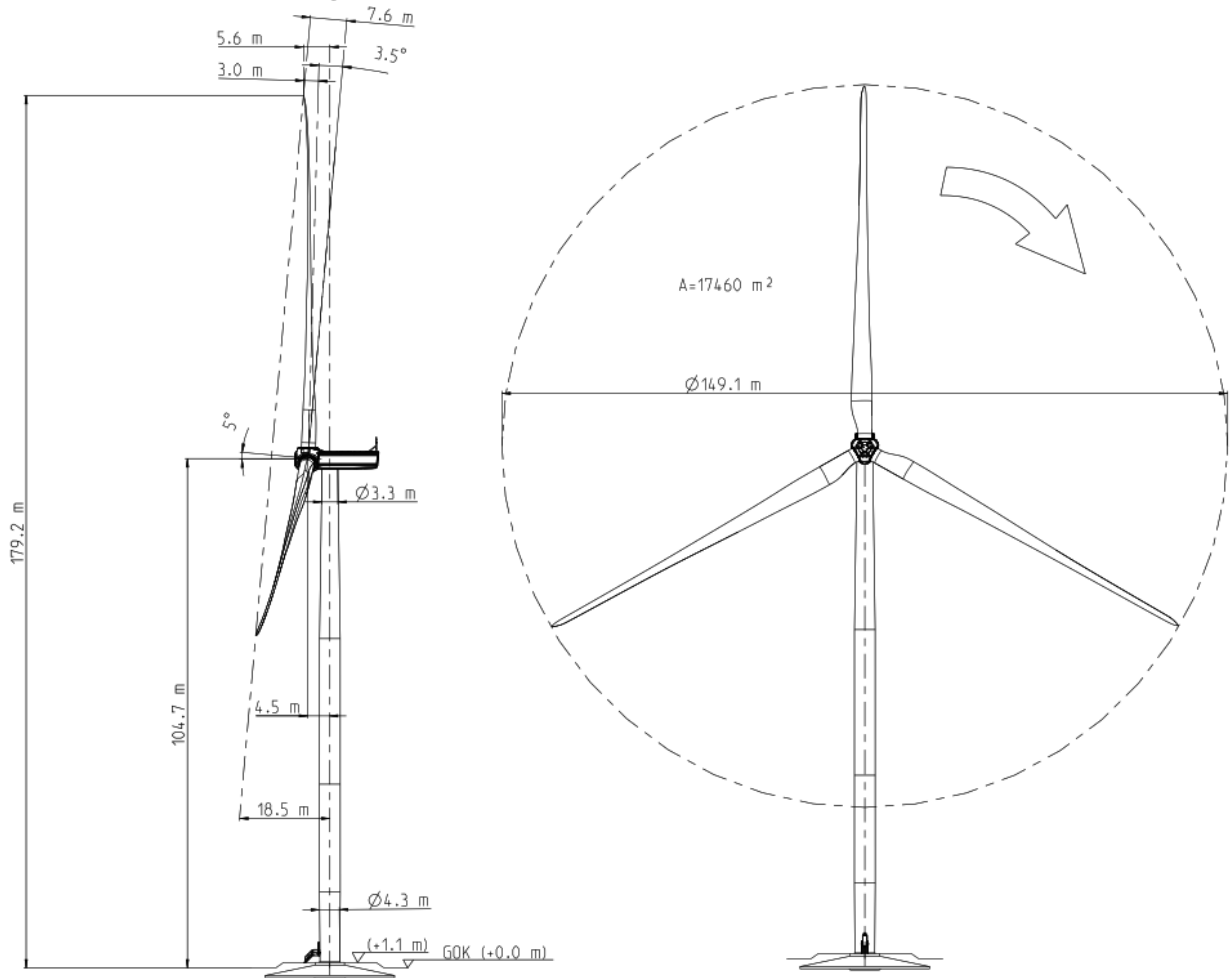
Plan d'élevation NORDEX - N149 - 4.5MW
